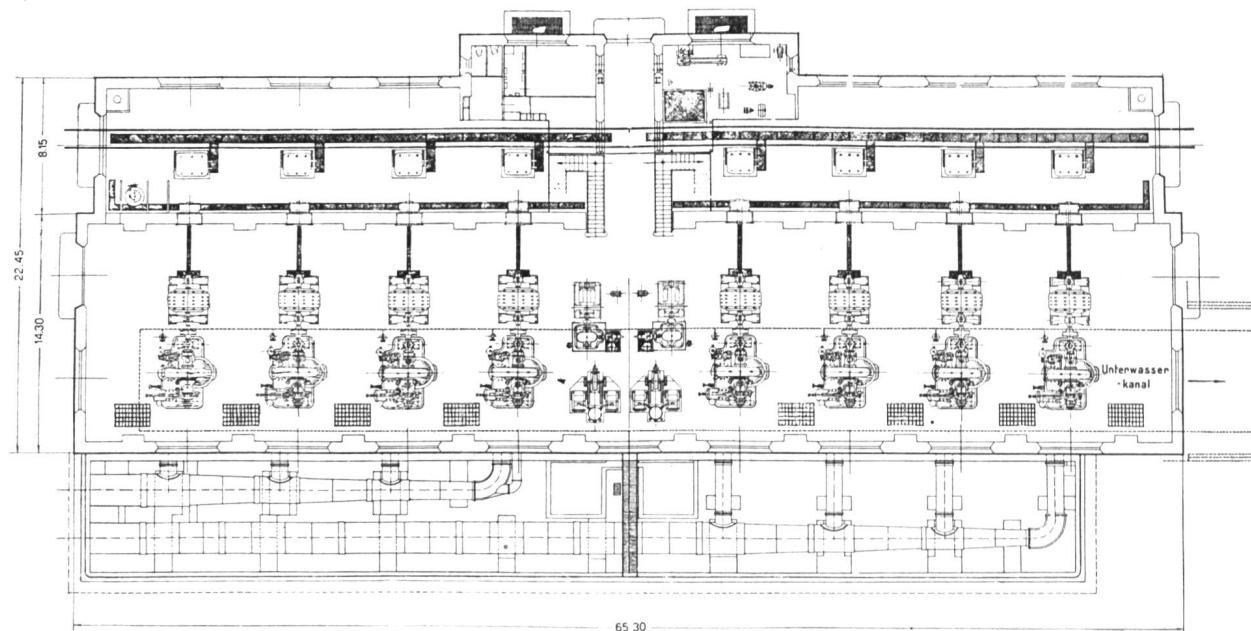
Grundriss des bestehenden Maschinenhauses des Kraftwerkes Albula der Stadt Zürich. Maßstab 1:500.
